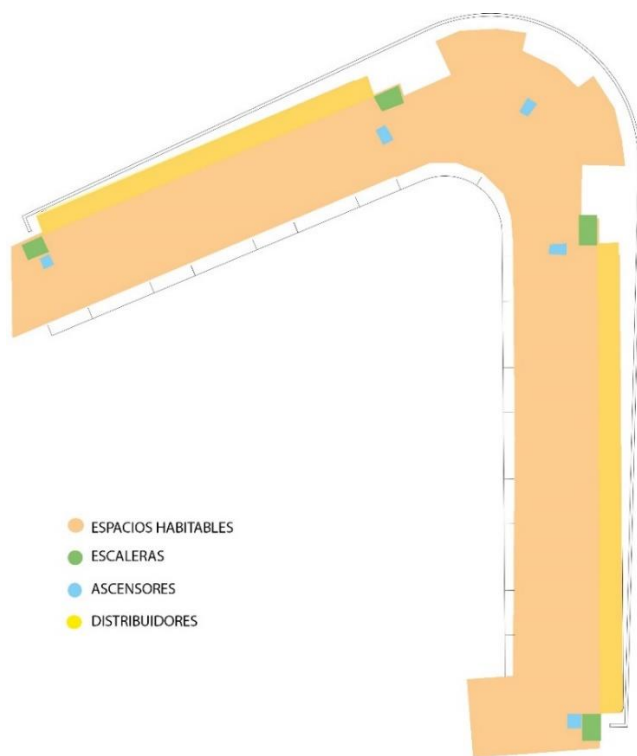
Esquema en planta de las circulaciones verticales y horizontales
